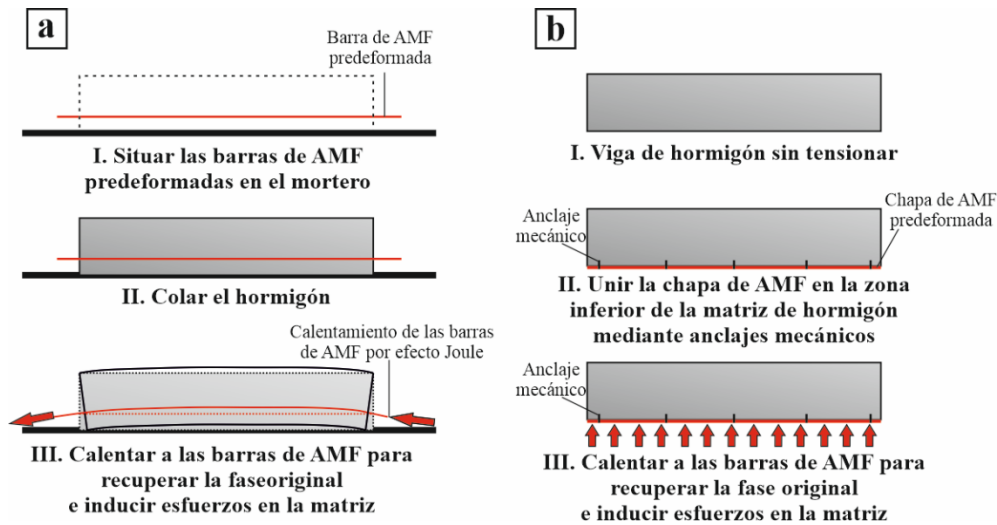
Esquema simplificado del proceso de fabricación de vigas de hormigón con AMF: a. pretensado. b. postesado.
